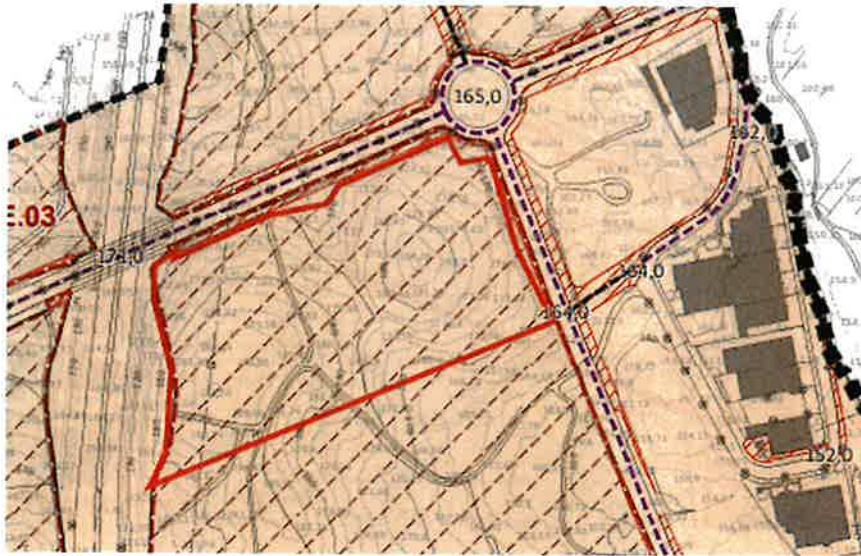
Planta de Zonamento - Programação e Execução
